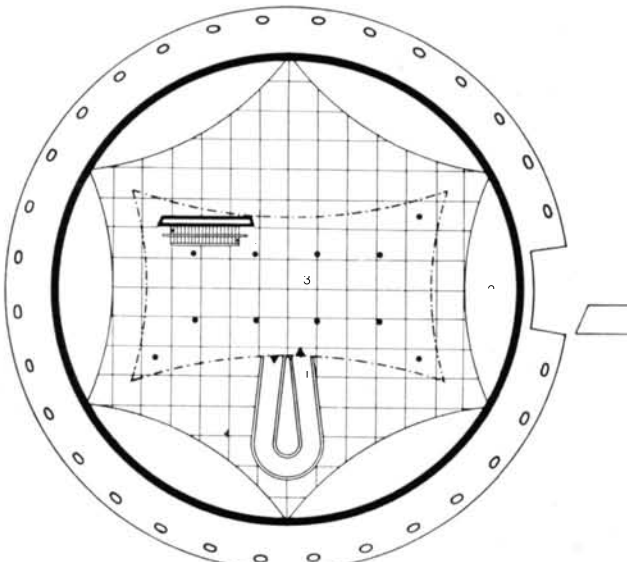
2.º PAV. - PLANTA BAIXA
